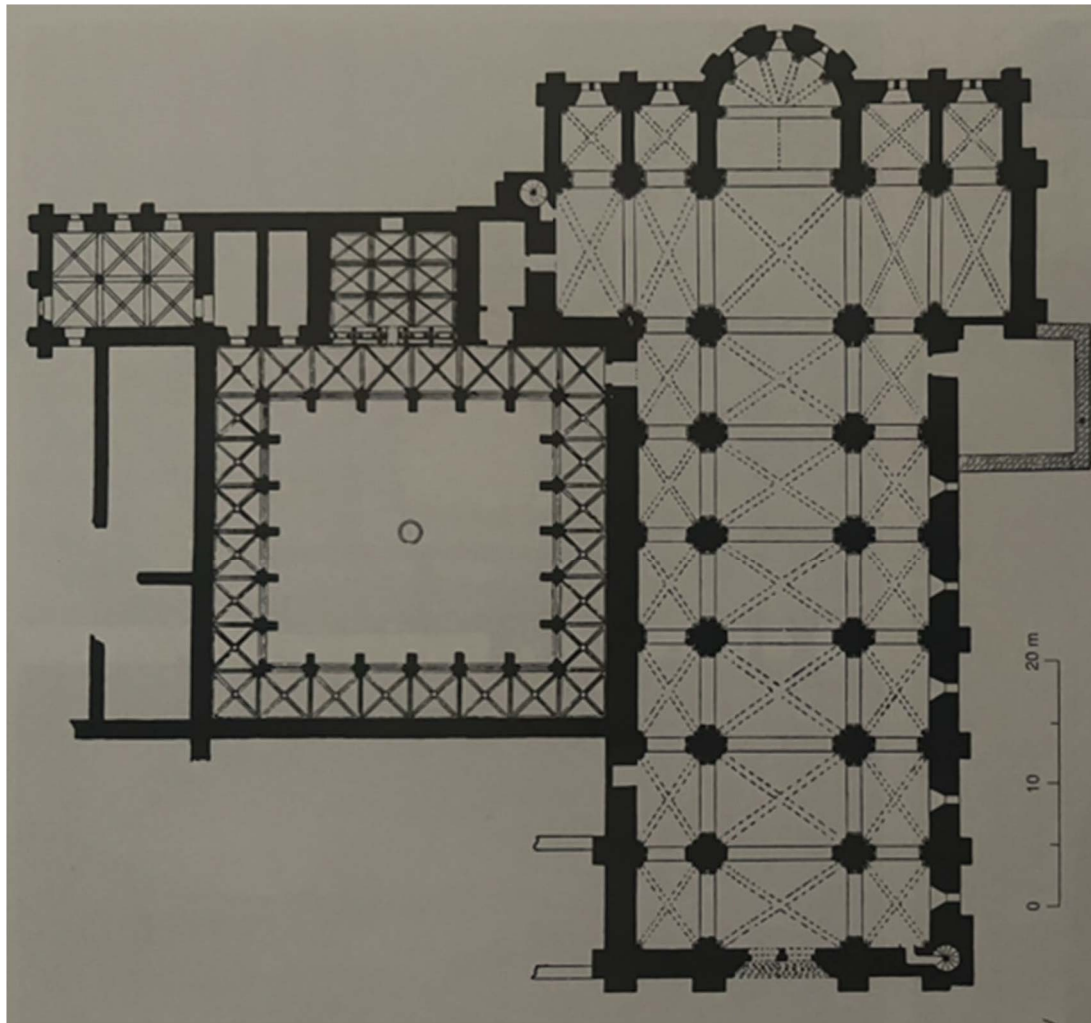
La Oliva, Santa María la Real, Grundriss der mittelalterlichen Bauteile des Klosters und der Kirche, Roncal/V. Lampérez, 1908.
